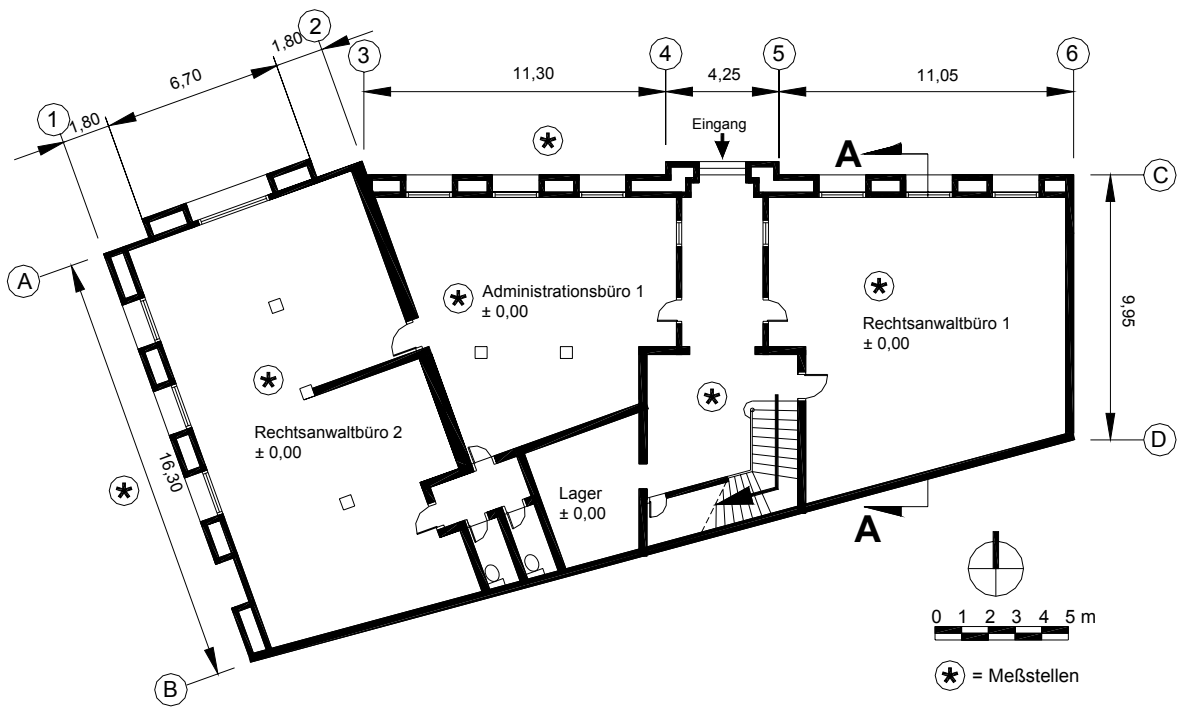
Grundriss Erdgeschoss von Gebäude B3
